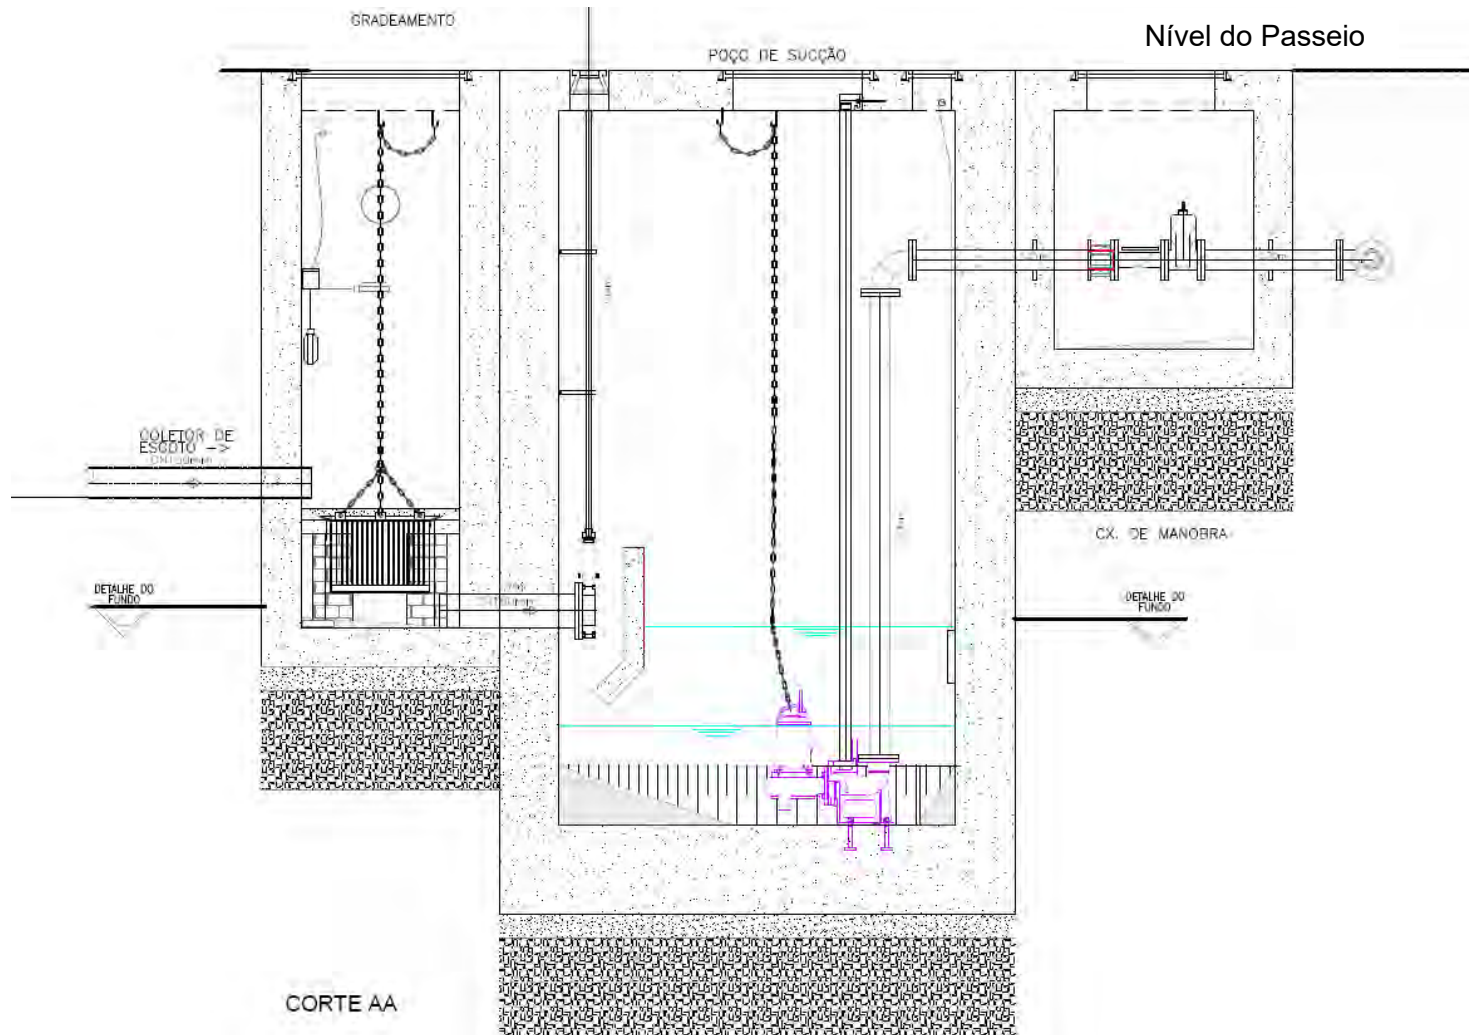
Planta Padrão de Estações Elevatórias de Esgoto de Pequeno e Médio Porte
